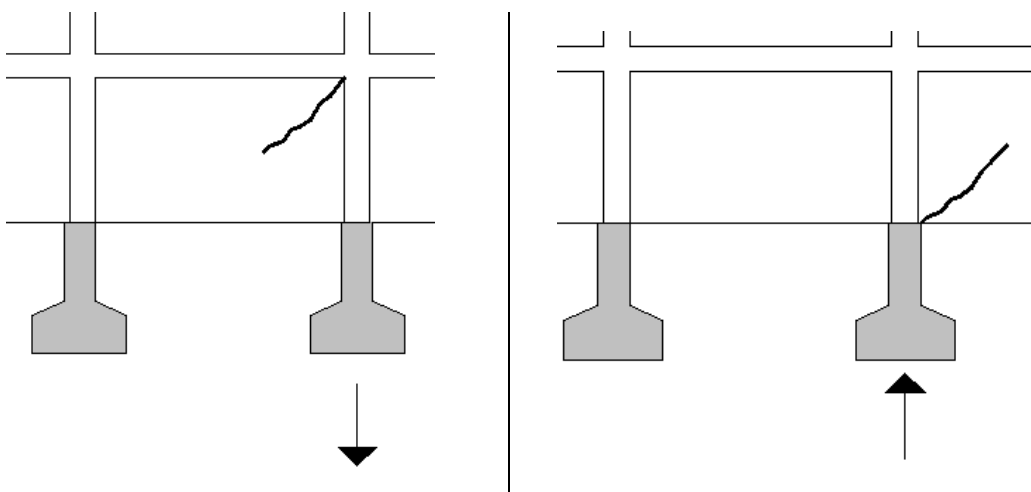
Fissuras provocadas pelo assentamento ou levantamento da fundação numa estrutura (Modificado, Ortiz, 1983).
